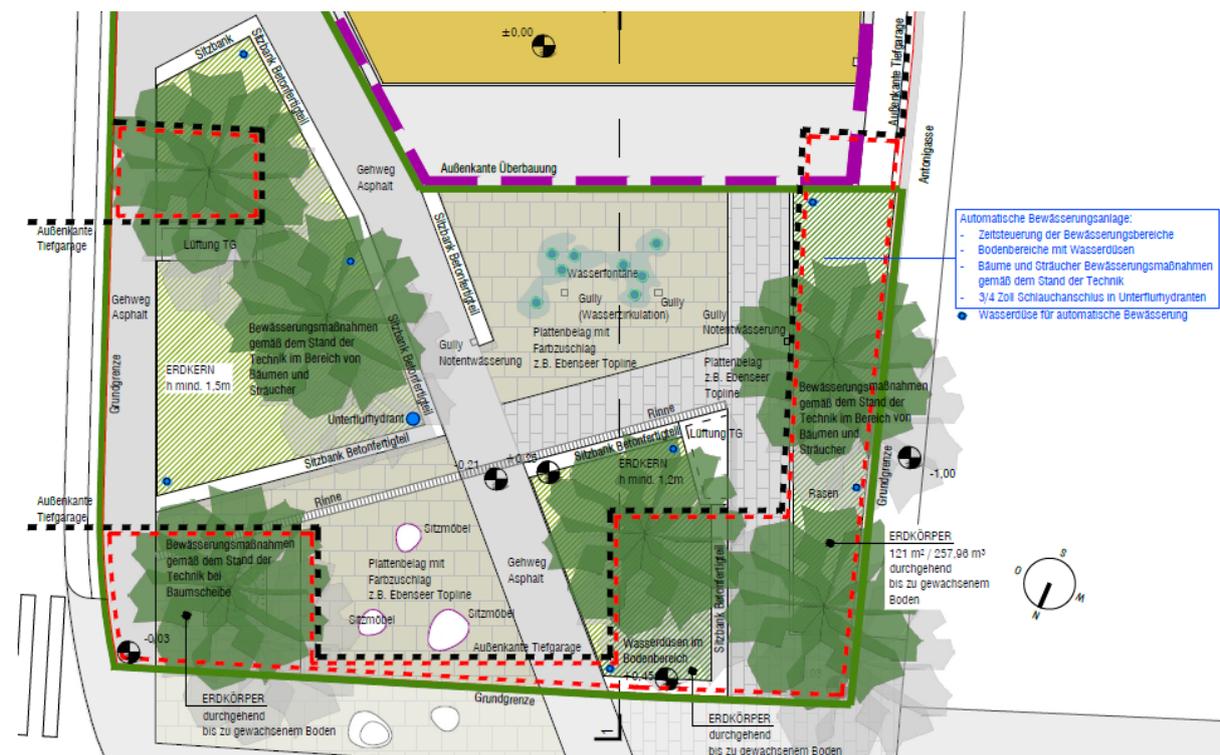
Geplante Gestaltung der Freifläche 1 (durchgehende grüne Umrandung)
